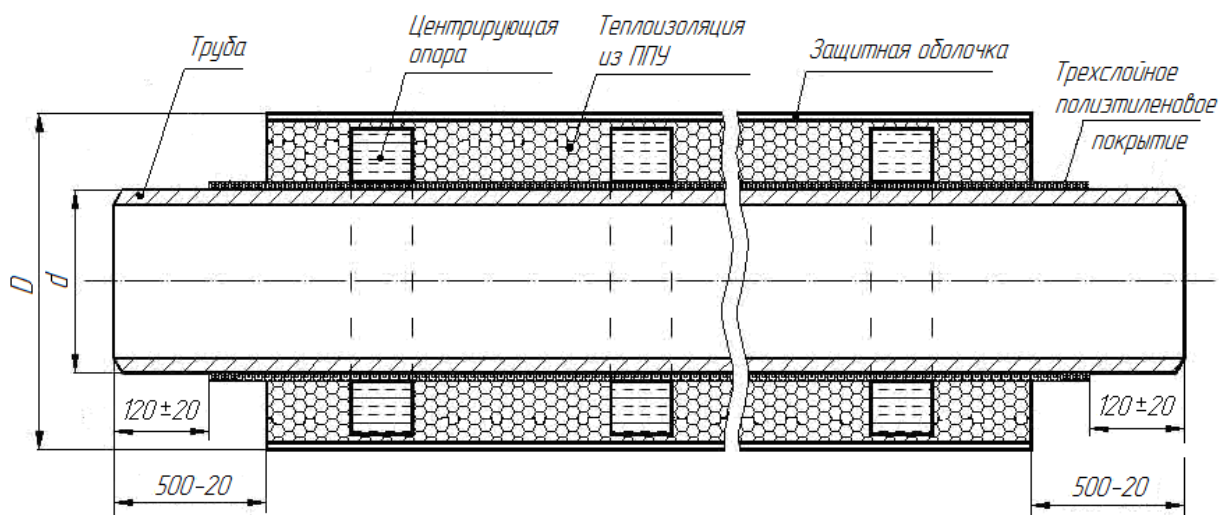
Конструкция трубы в теплоизоляции для подземной прокладки
